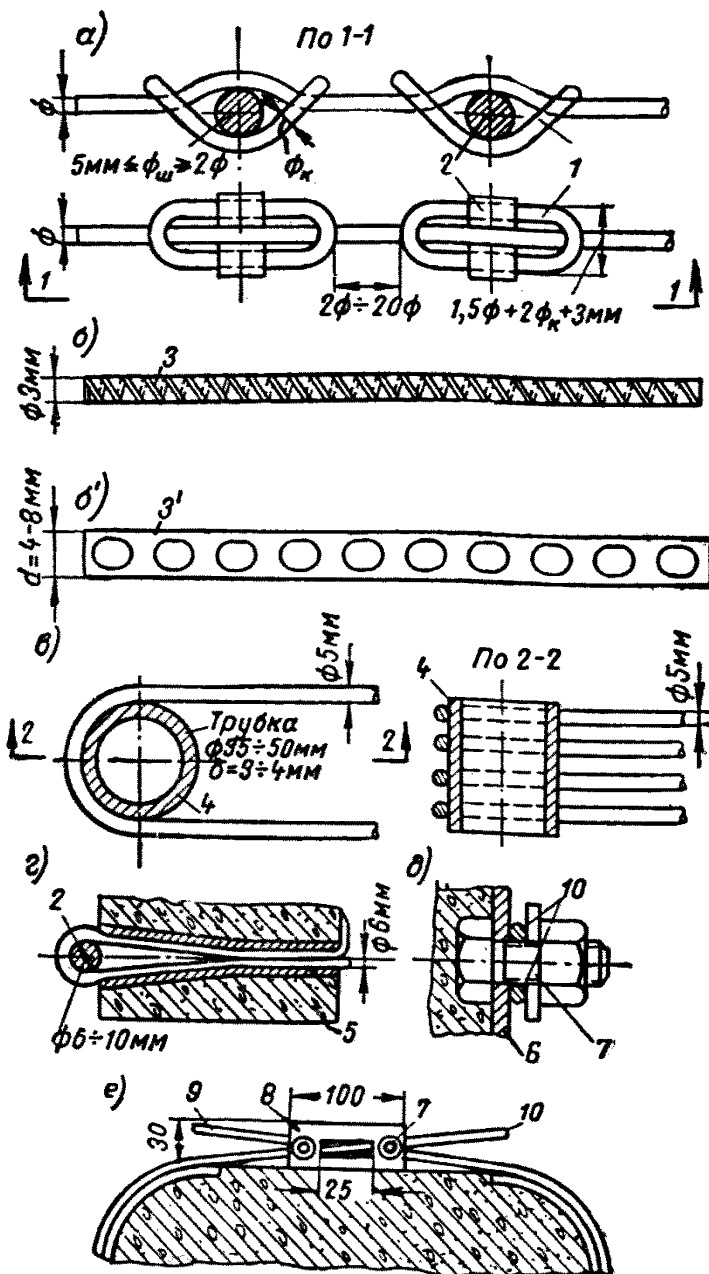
Анкеровка арматуры из твердых сталей в предварительно напряженных железобетонных конструкциях
